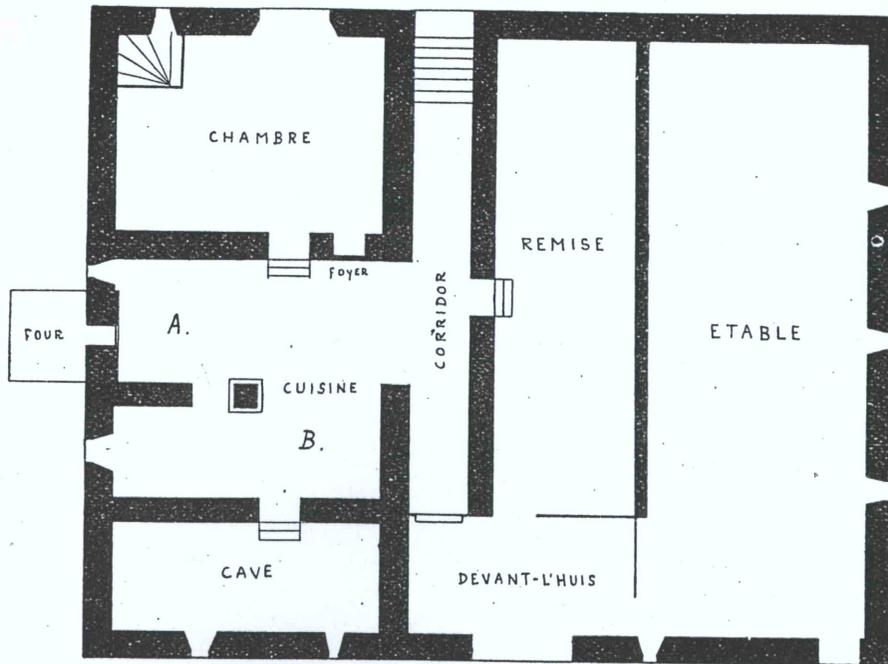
REZ-DE-CHAUSSÉE DU N° 8 DES REPRISES
